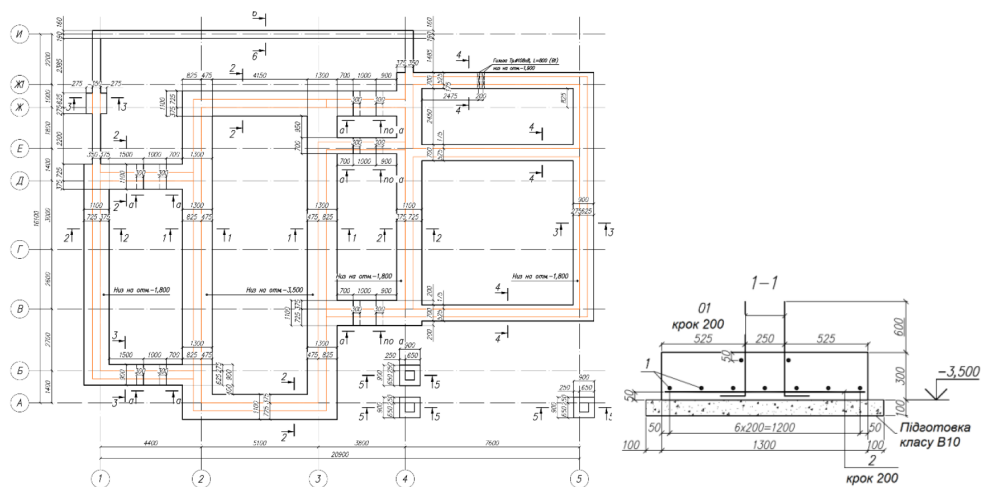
Схема розташування фундаментів: а – на відмітці -3.500 ; -1.800 ; б – розріз по осі 1-1
